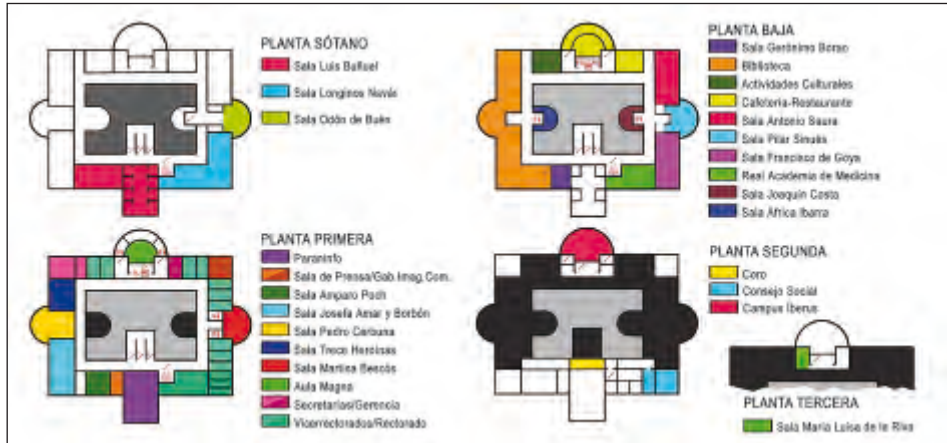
Plantas del Edificio paraninfo tras su restauración.
